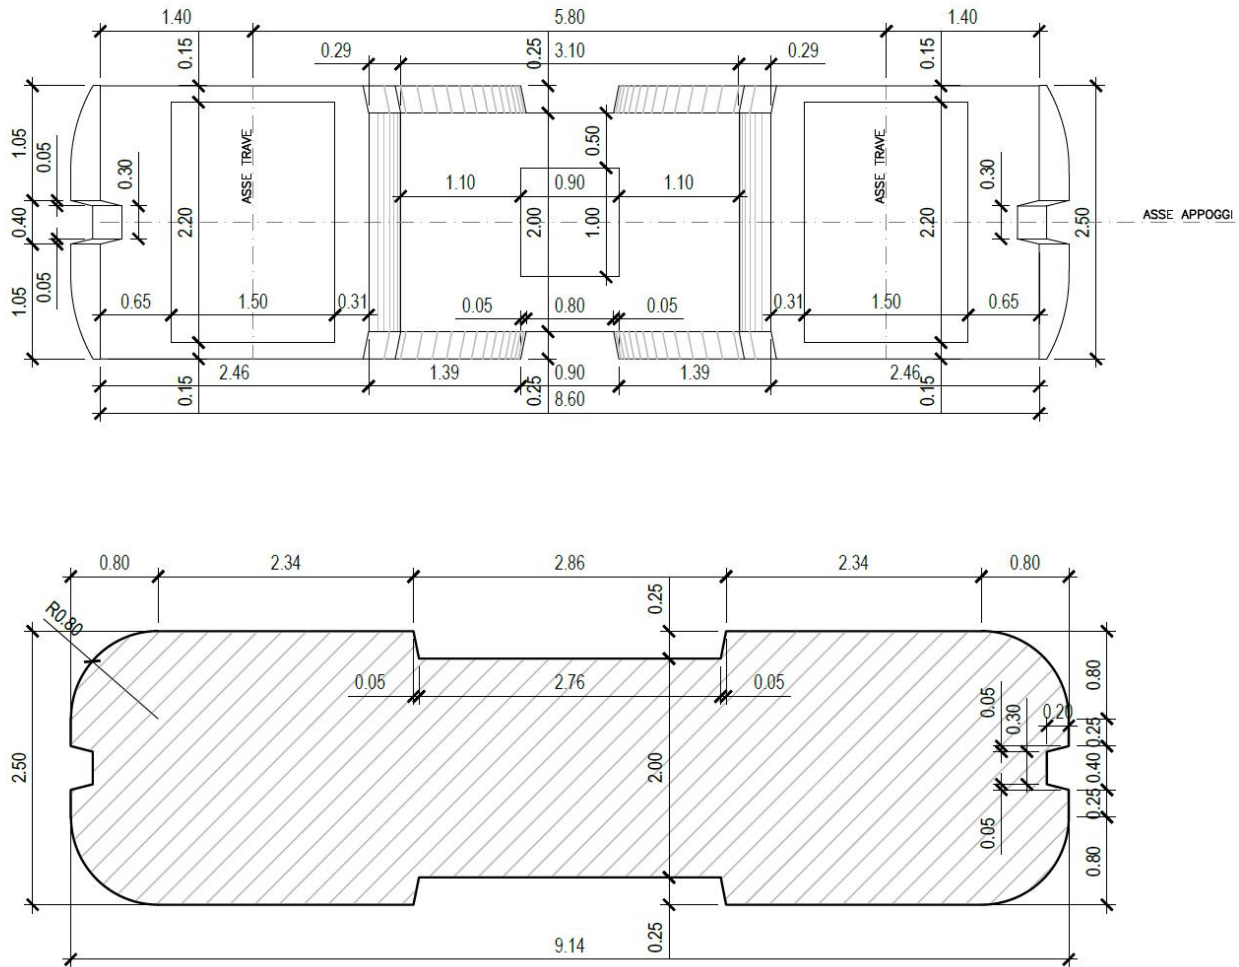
Vista Tipica dall'alto e Sezione Tipica sotto pulvino (uguale per tutte le pile). a
